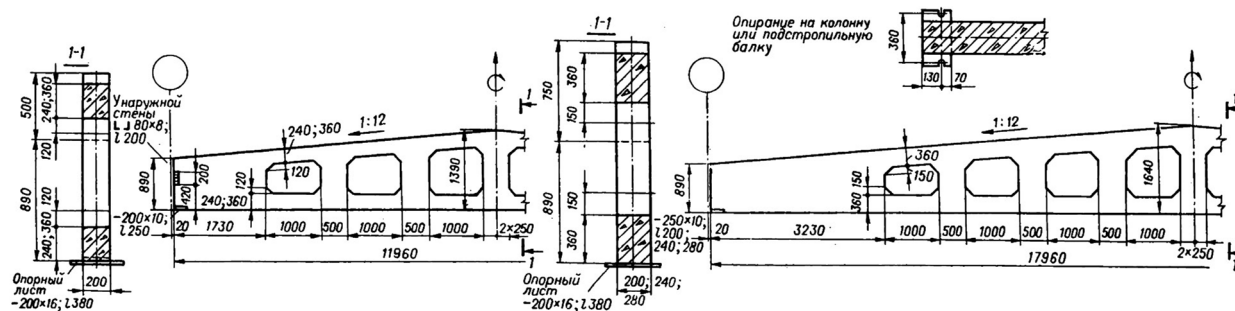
Железобетонные решетчатые стропильные балки для скатной кровли пролетом 12 и 18 м при шаге 6 и 12 м (серия 1.462-3)
